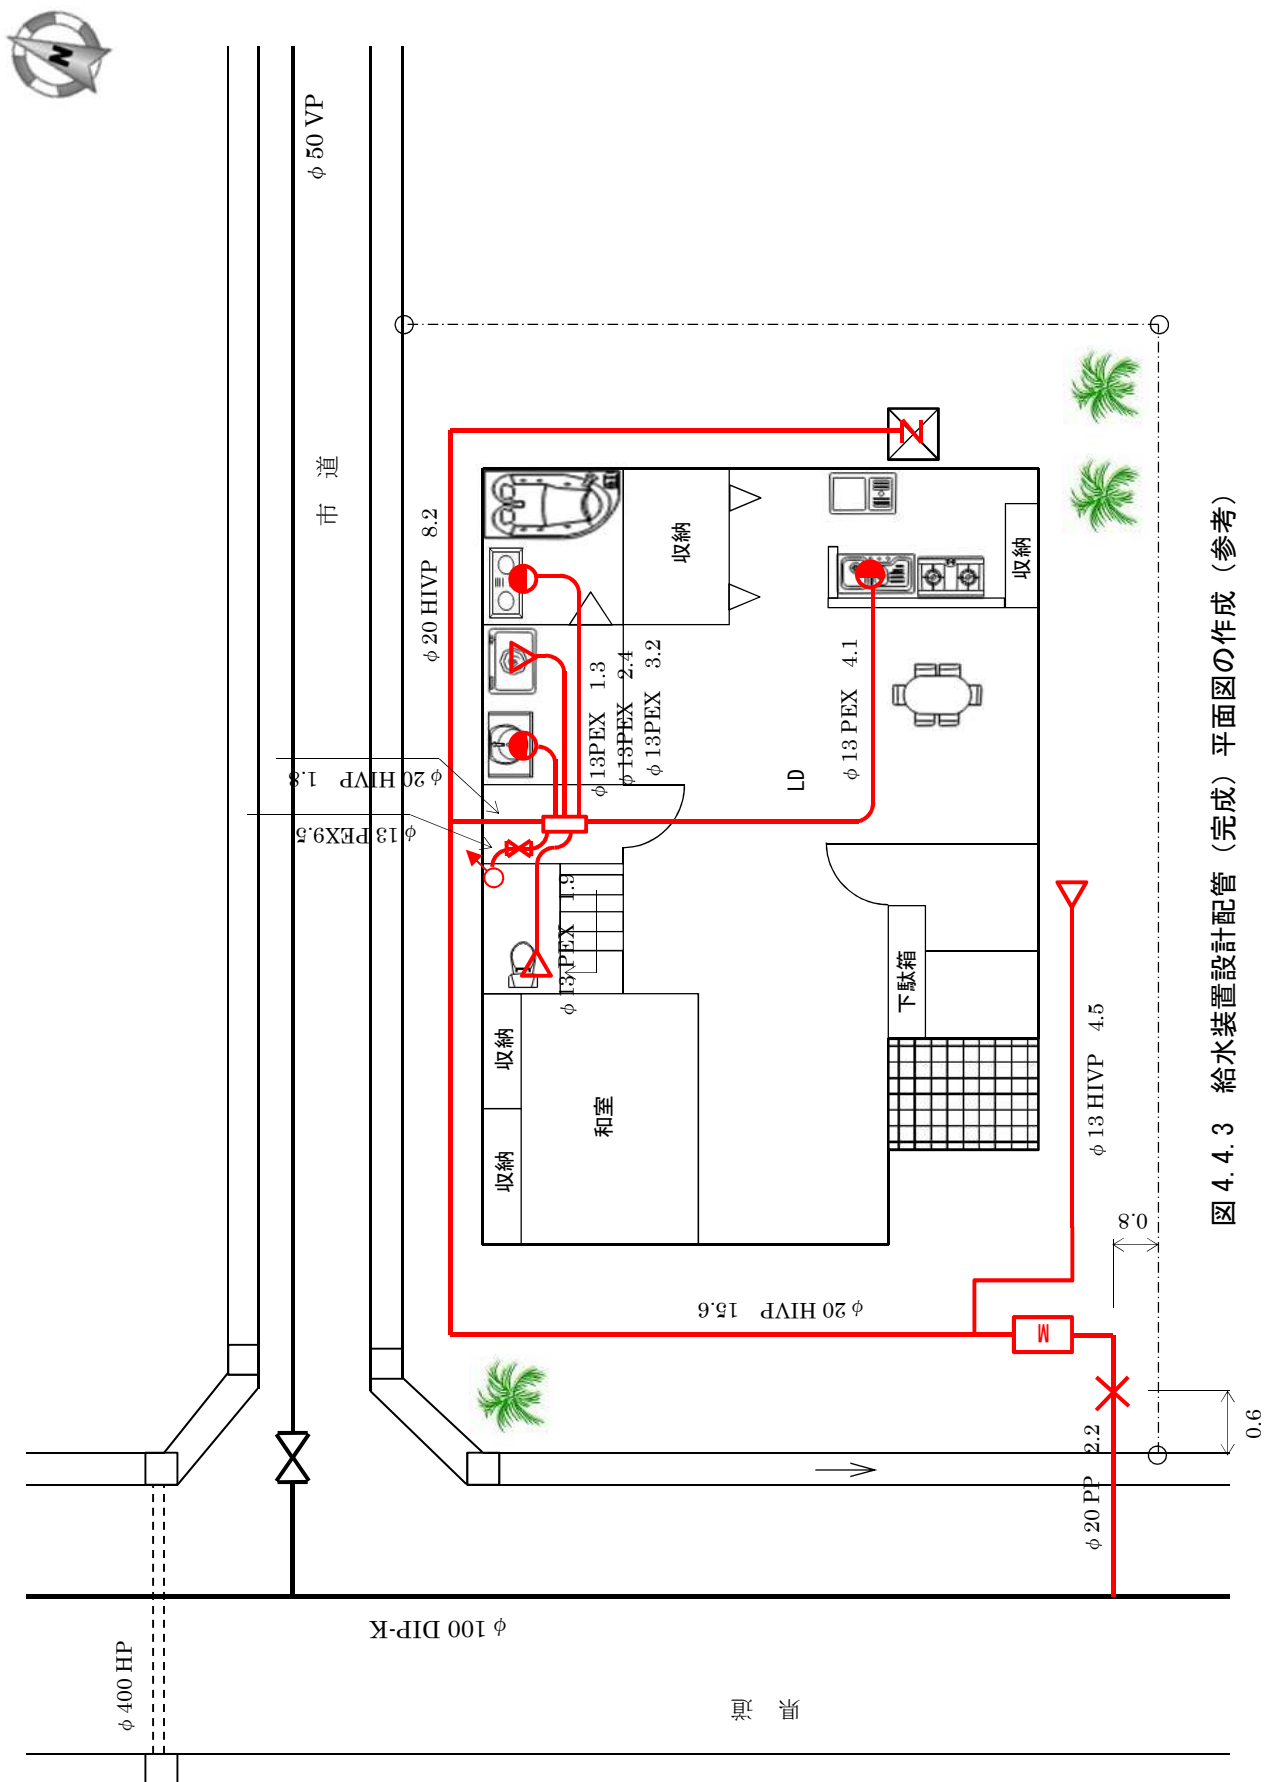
給水装置設計配管 (完成) 平面図の作成 (参考)
